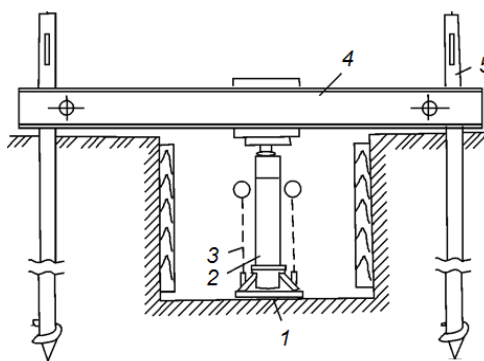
Схема испытания грунта штампом в шурфе:
